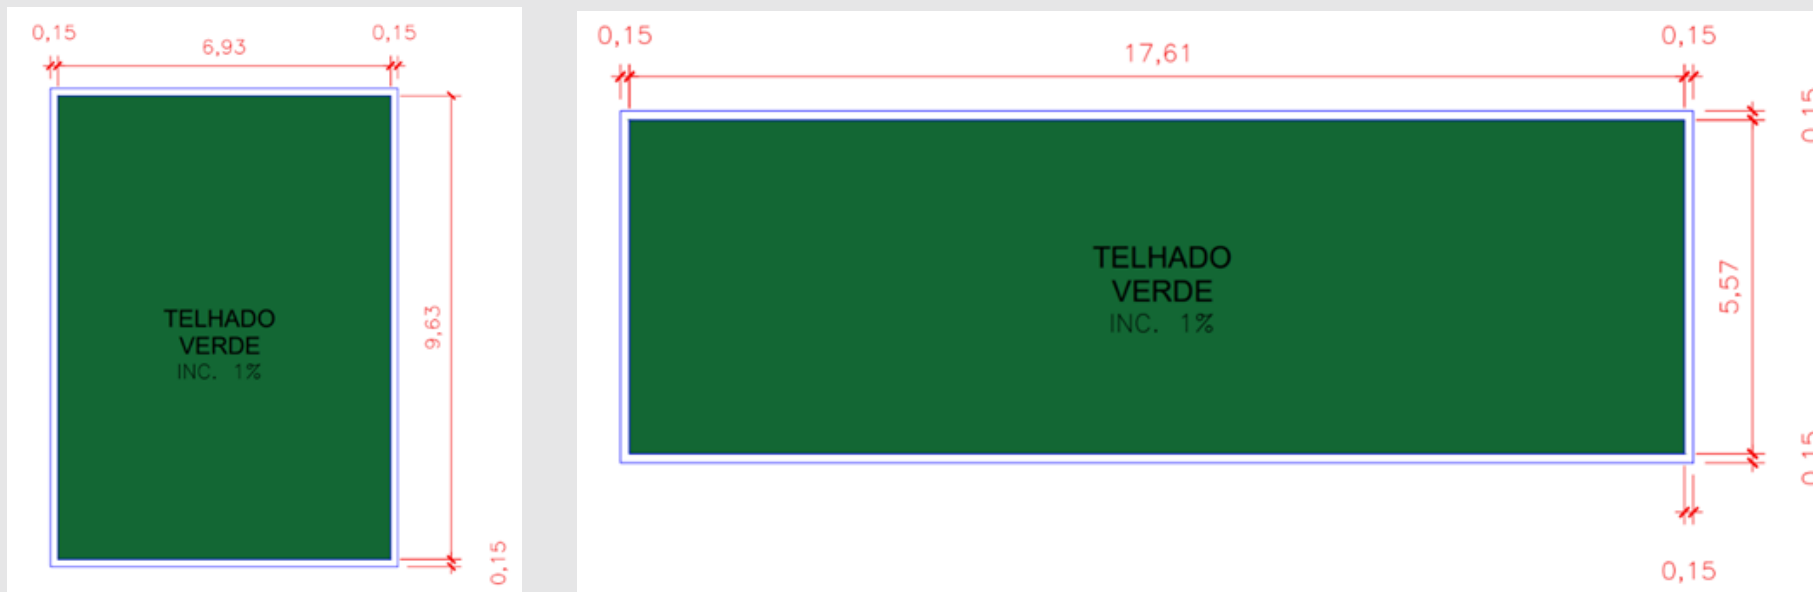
Planta de Cobertura yoga e planta de cobertura SPA/academia/ sala de jogos
